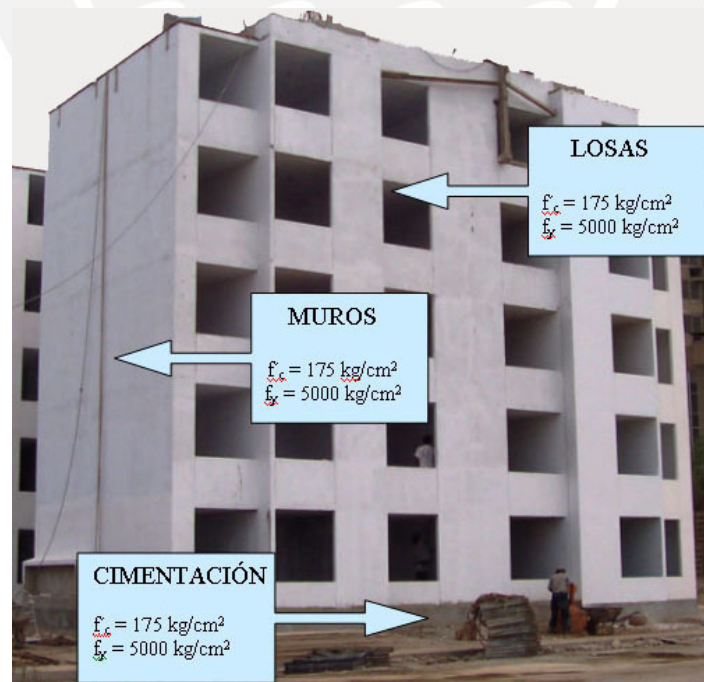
Conjuntos Estructurales del EMDL Típico
